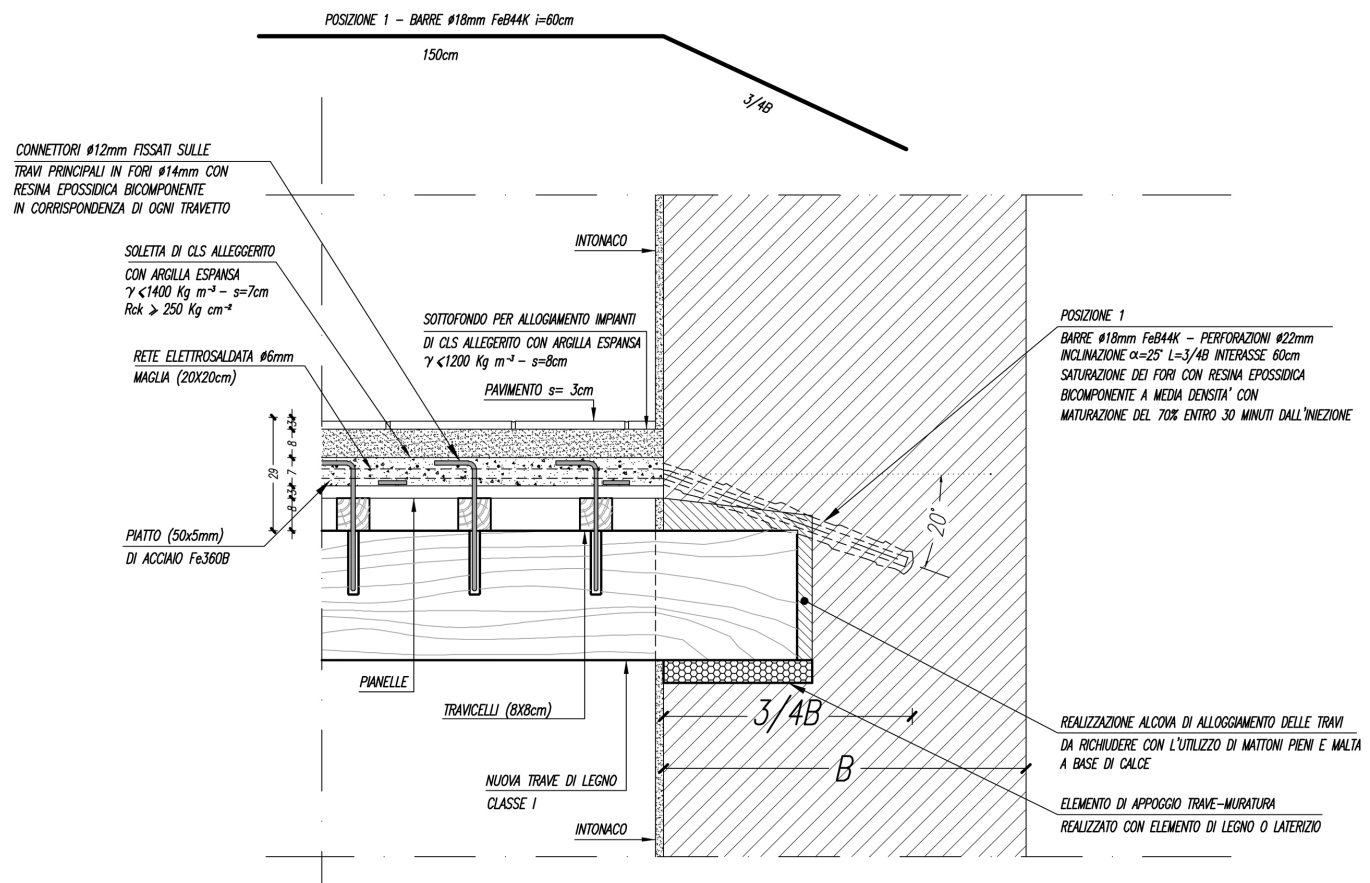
b – Collegamento della soletta in calcestruzzo alleggerito alle murature portanti perimetrali per mezzo di perforazioni armate
